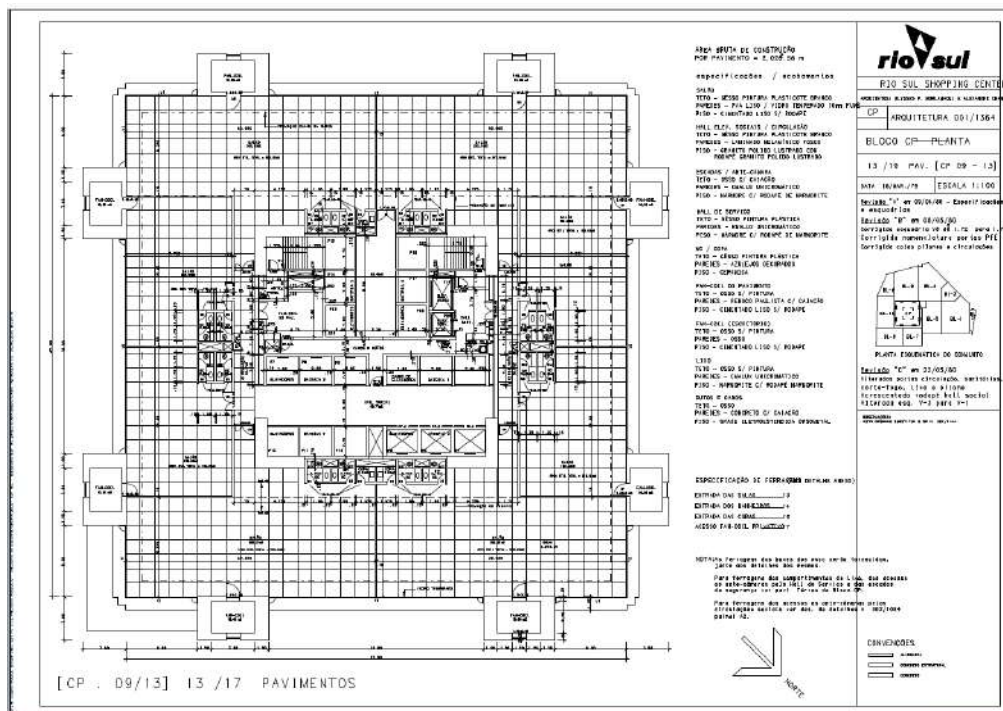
Torre Rio Sul. Planta do 13º/19º Pavimentos, sem treliça na fachada.
